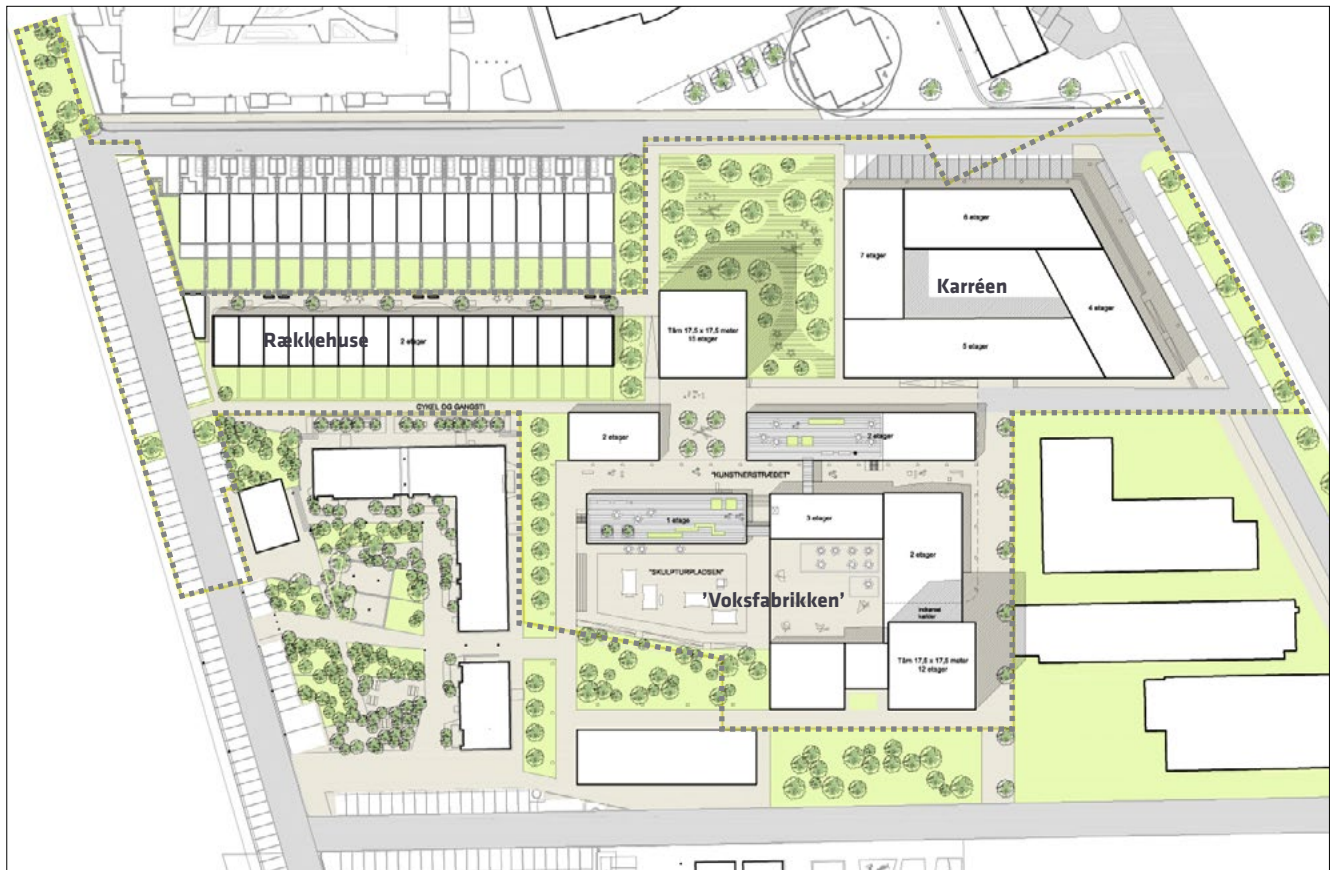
Illustration nr. 1 visende lokalplantillæggets bebyggelsesplan.
